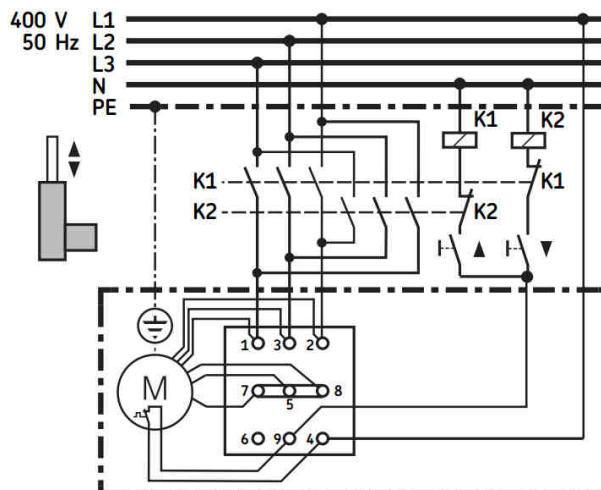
Zalecany przez Zamawiającego układ złączy na panelu przyłączeniowym.
